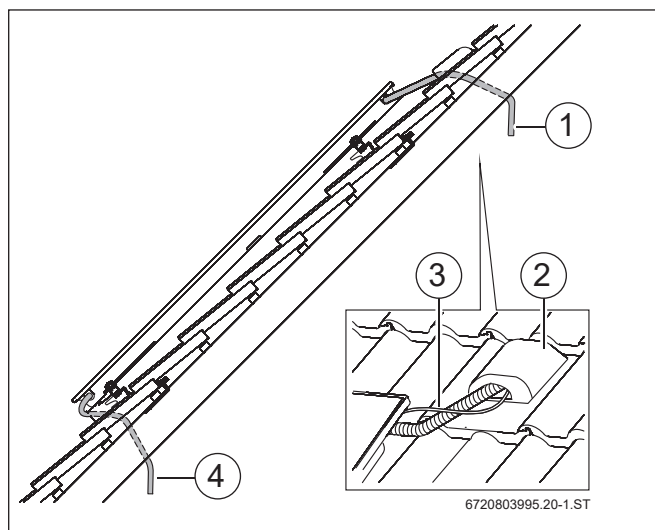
Zestaw przyłączeniowy Logasol SKT1.0 do montażu na dachu spadzistym / w połaci dachu
